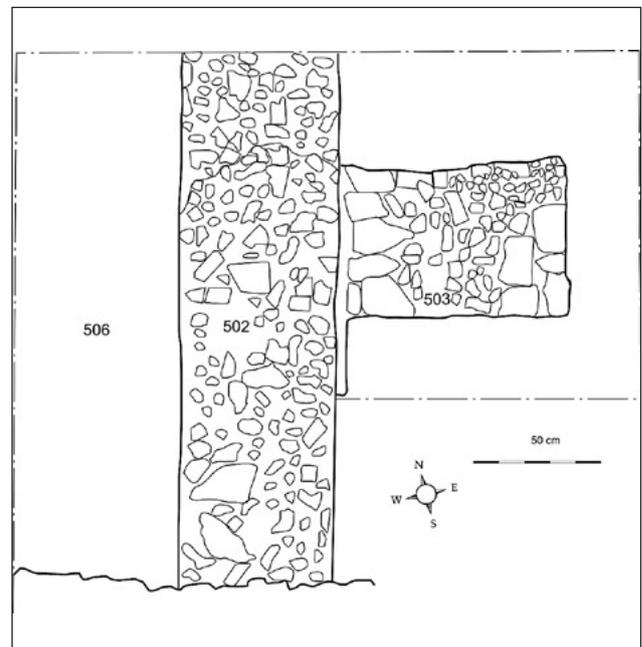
Pianta del settore 5, con le fondazioni della facciata e il pilastro in appoggio.
